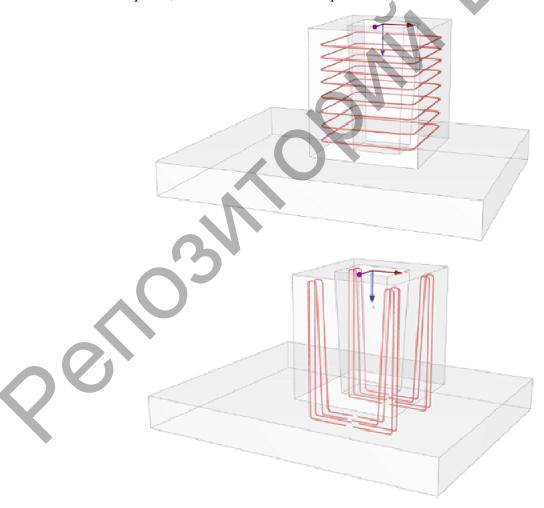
Армирование хомутами и петлями стаканной части фундамента.
